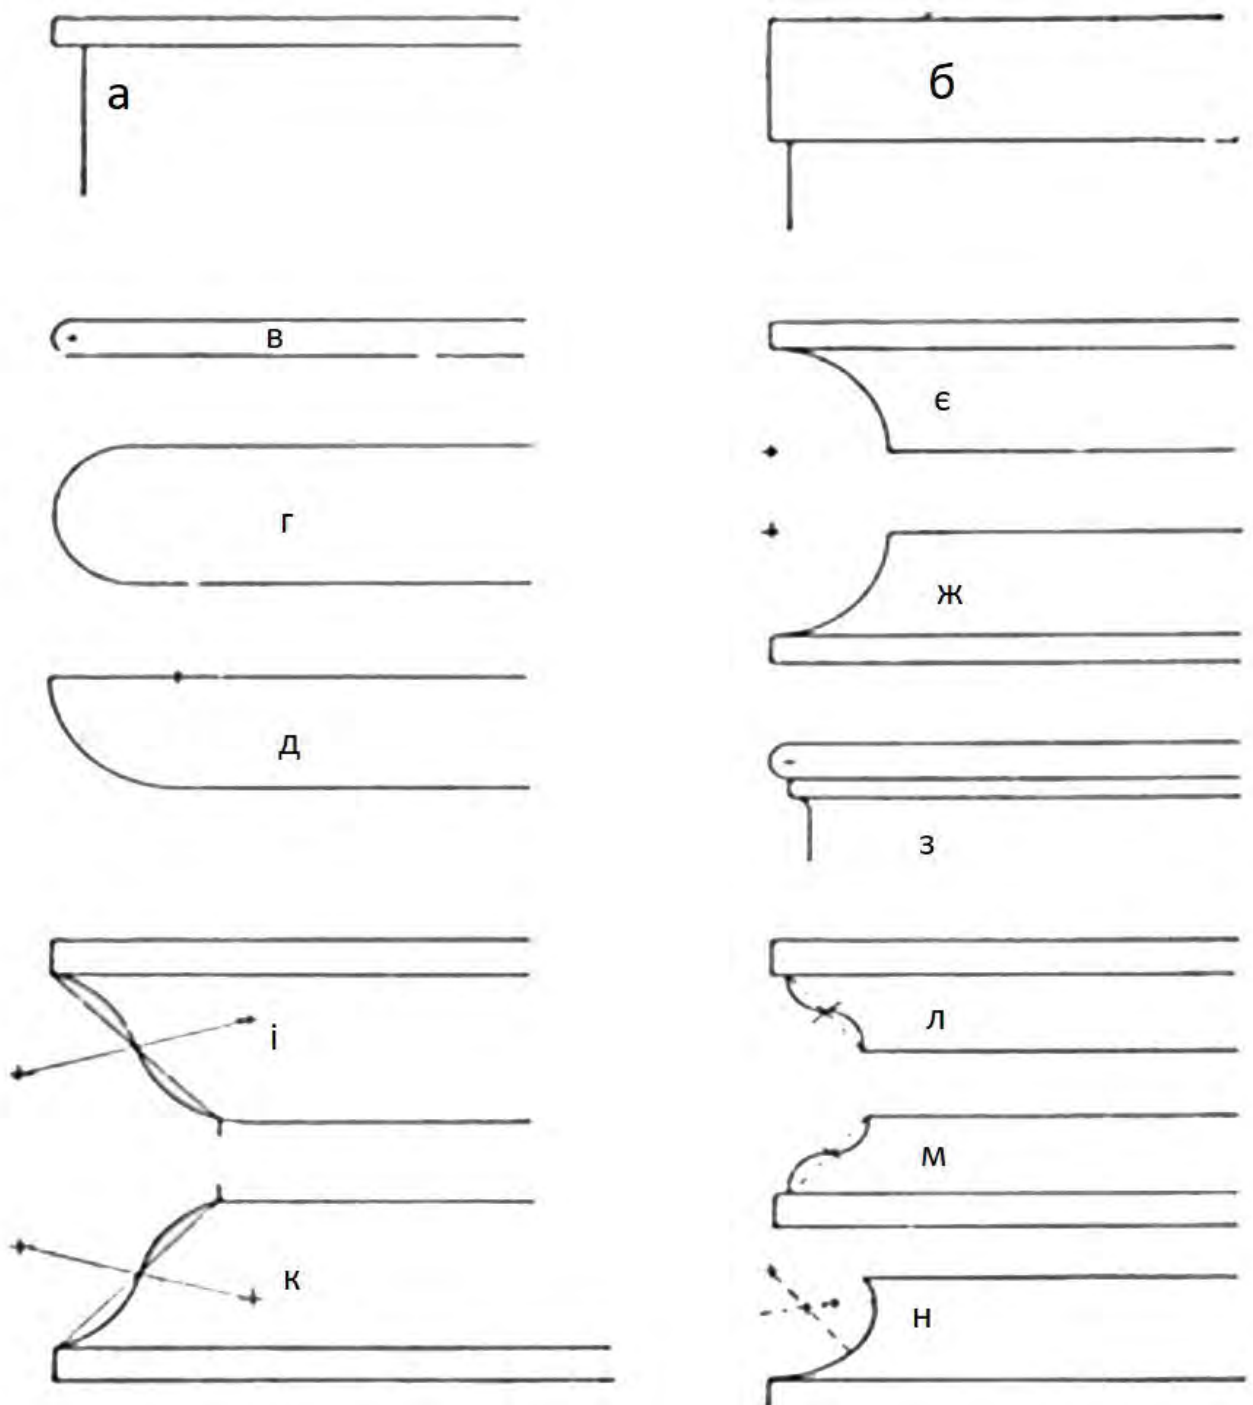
Обломи в ордерах Віньйоли: а - полочка; б - пояс; в - валик; г – вал (торус); д – четвертний вал; е – викружка; ж - зворотна викружка; з - астрагал; і - гусьок; к - зворотній гусьок; л - каблучок; м - зворотній каблучок; н – скоція
